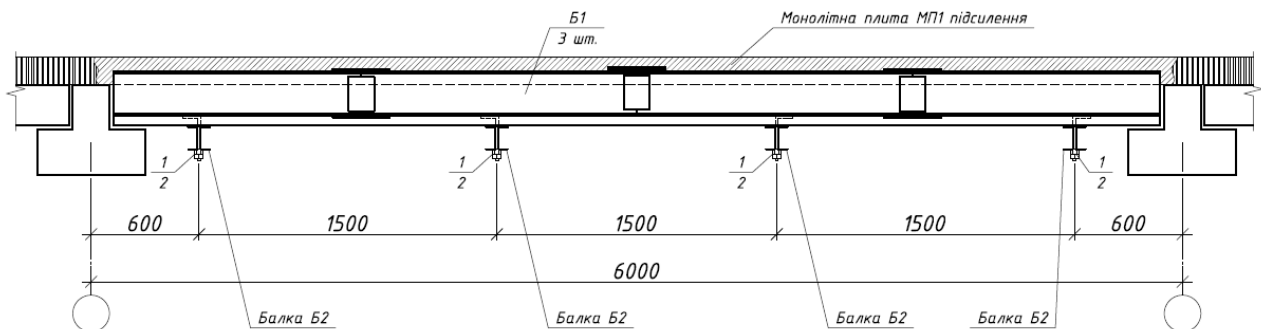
Схема підсилення конструкцій перекриття, повздовжній розріз.
